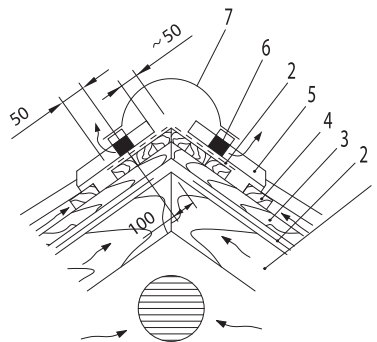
Конструкция кровли с двумя вентиляционными зазорами
